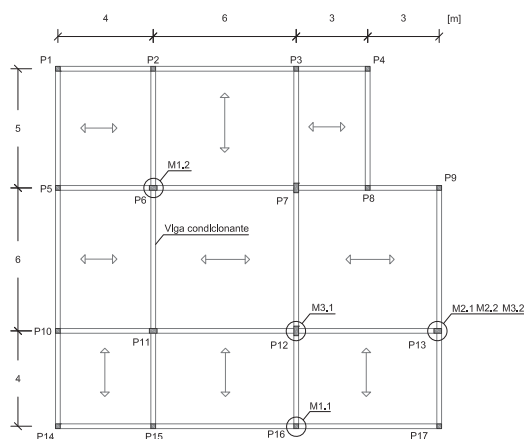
Elementos estruturais condicionantes nas estruturas de dimensionamento e com ligações semi-rígidas
